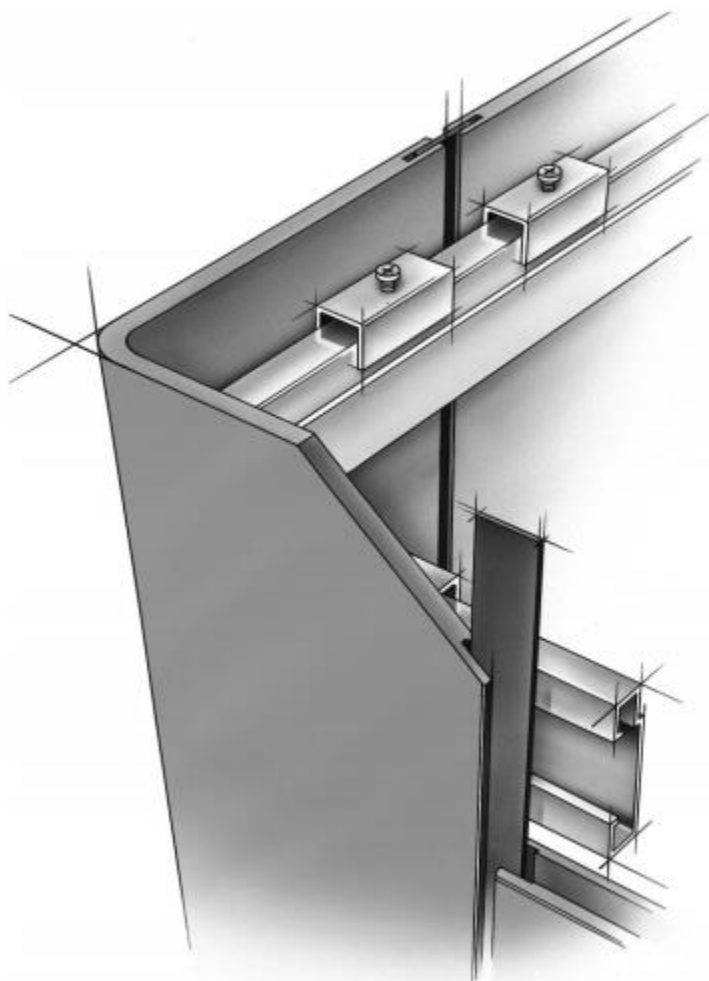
Coupe horizontale d'une fixation invisible avec colliers de suspension
